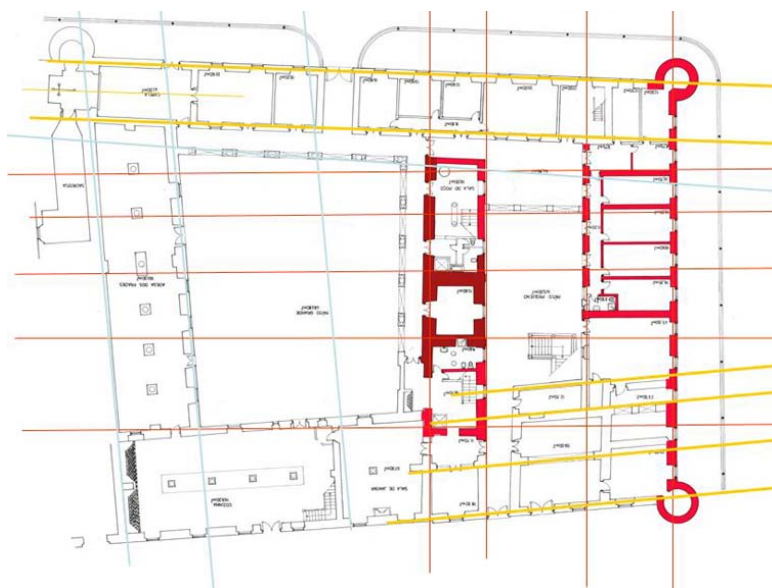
| FASE IV: Cerca de 1560-1600(?) Planta conjectural: amplificação do conjunto, construção de um claustro de serviço
